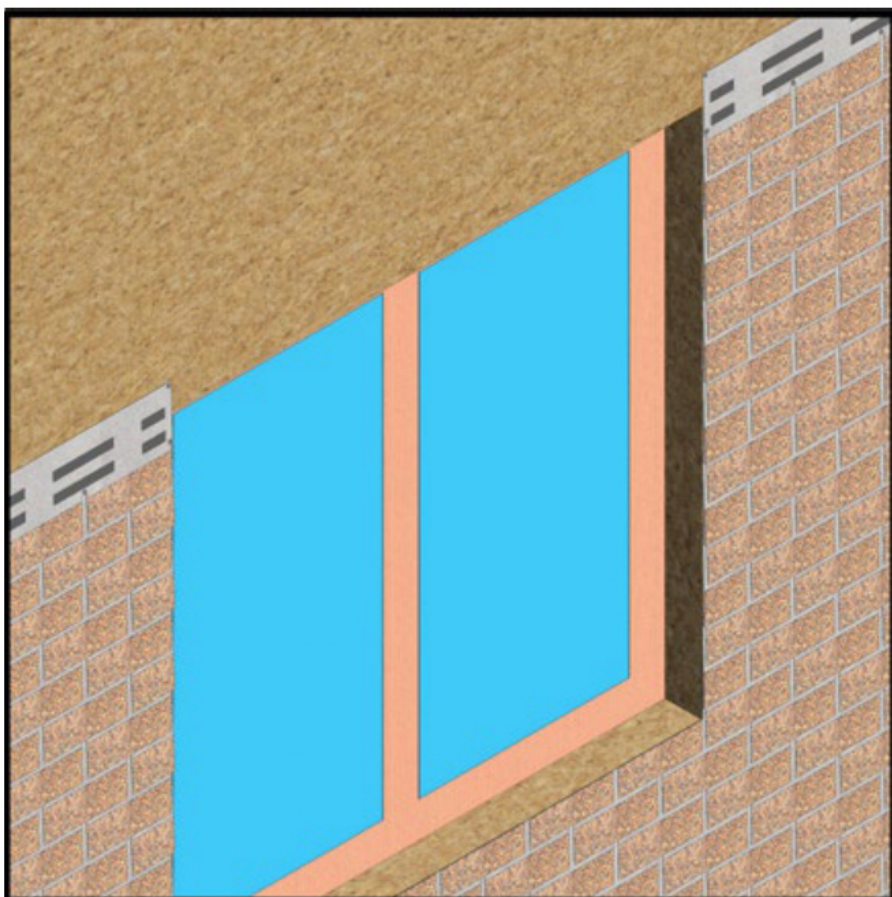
Монтаж фасадной плитки вокруг оконного проёма.
